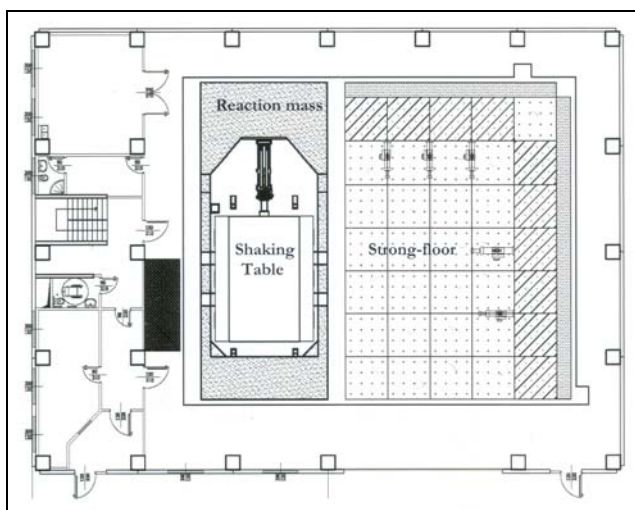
Pianta del laboratorio TREES Lab (Pavia).
